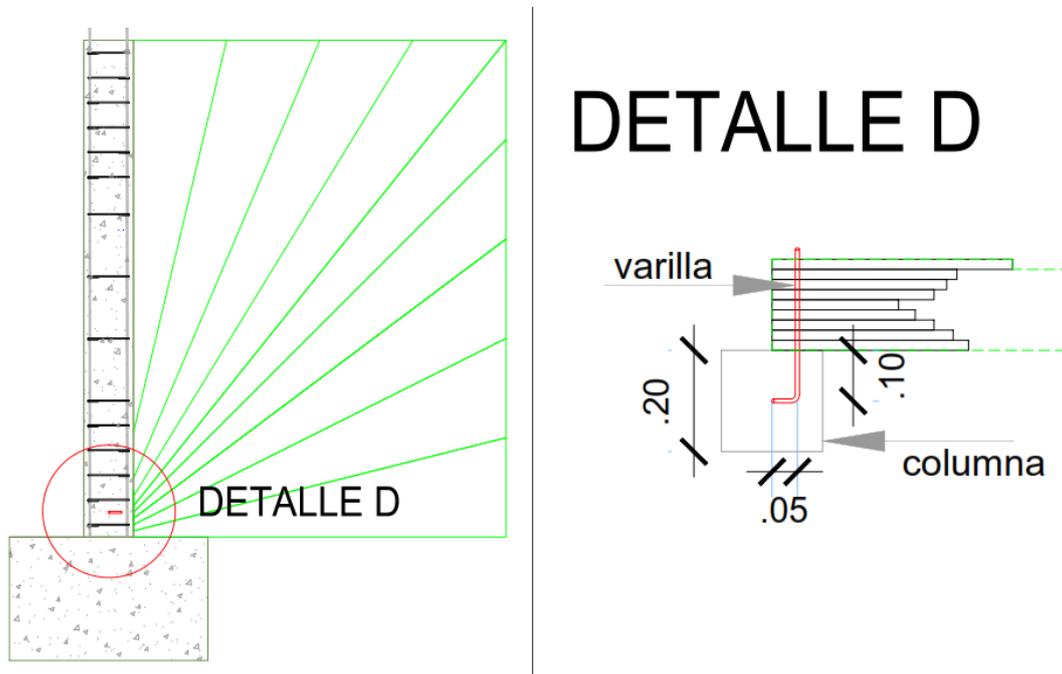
Detalles de anclaje para puerta en abanico en columna de hormigón armado o perfil metálico.
